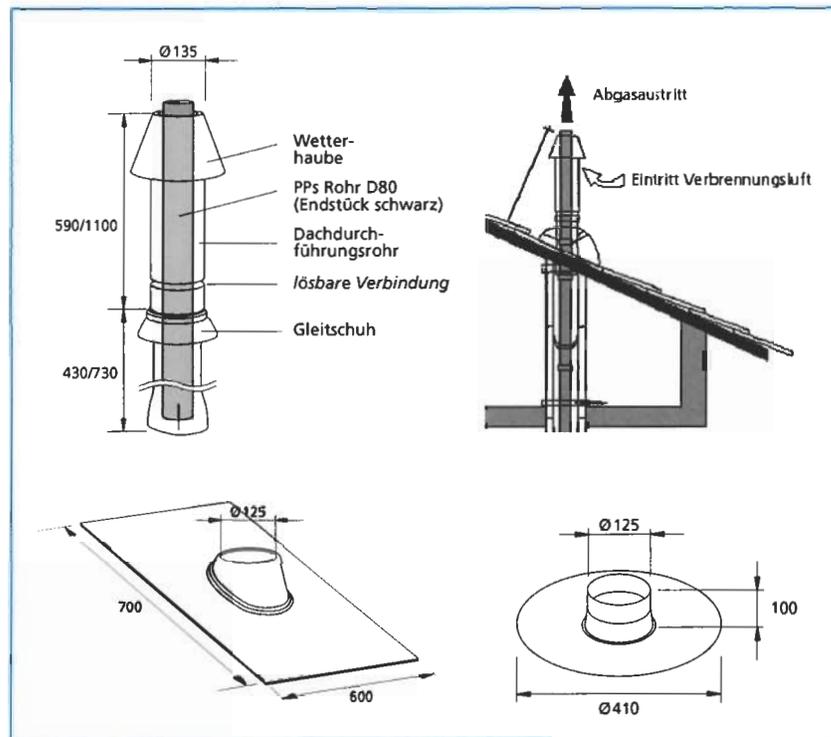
Dachdurchführung Zubehörteil für schräge Ziegeldachflächen und für Flachdächer.
